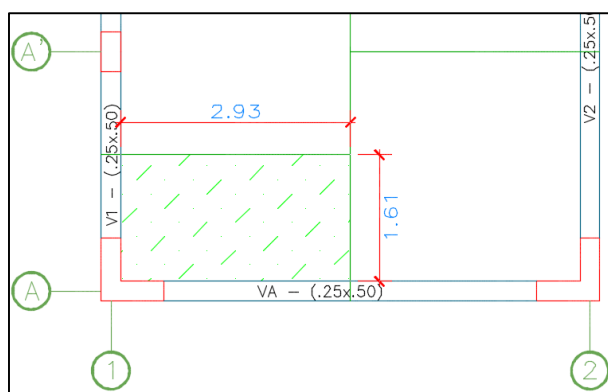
Área tributaria de la columna “A1” - Sistema aporticado
